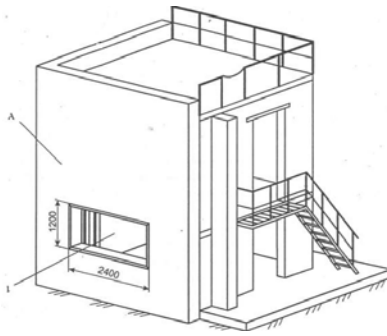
Фрагмент будинку: А – стіна, яка призначена для монтажу фасаду, 1 – віконний проріз
